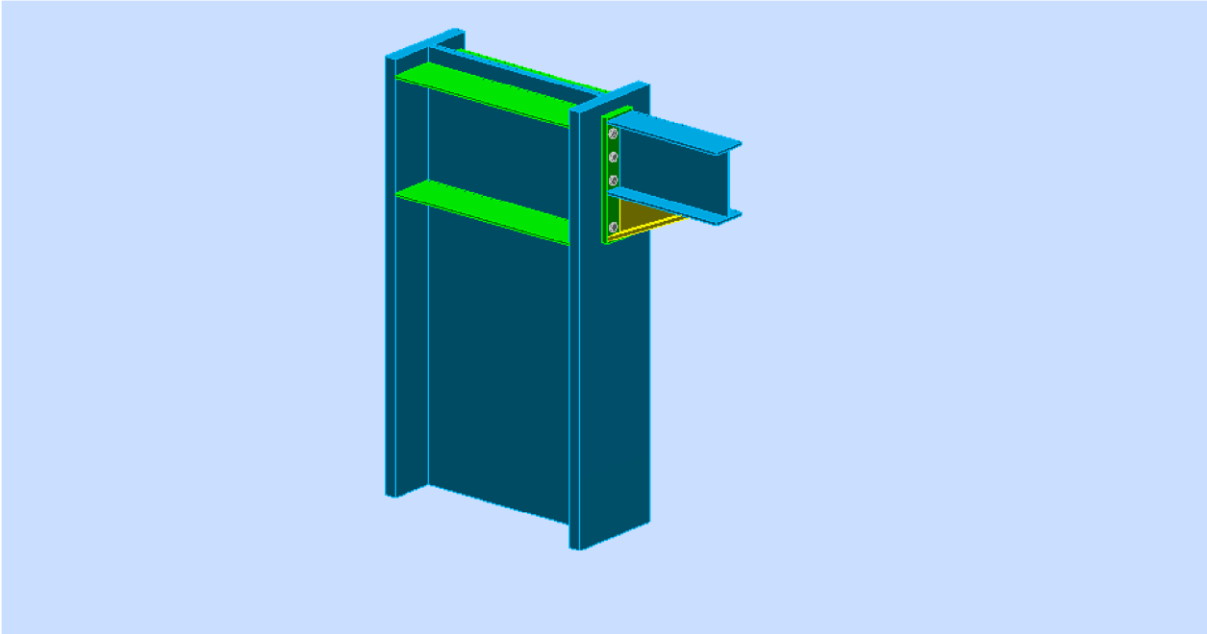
2 : Assemblage Poteau – poutre secondaires .
